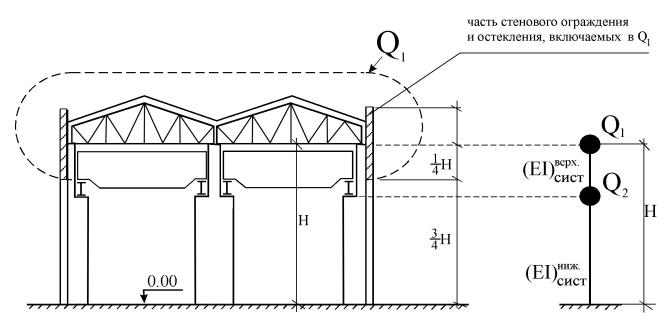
Формирование динамической расчетной схемы для производственного здания с мостовыми кранами
